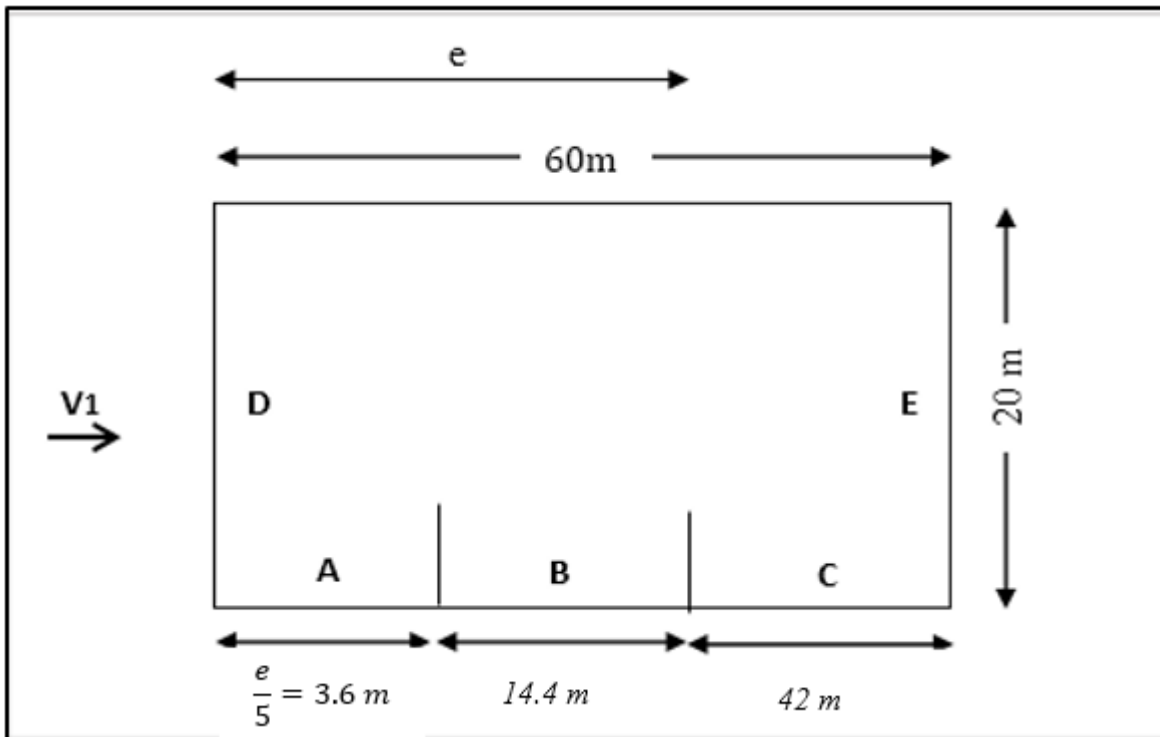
Vue en plan des zones de pression sur les parois verticales sens V1.
